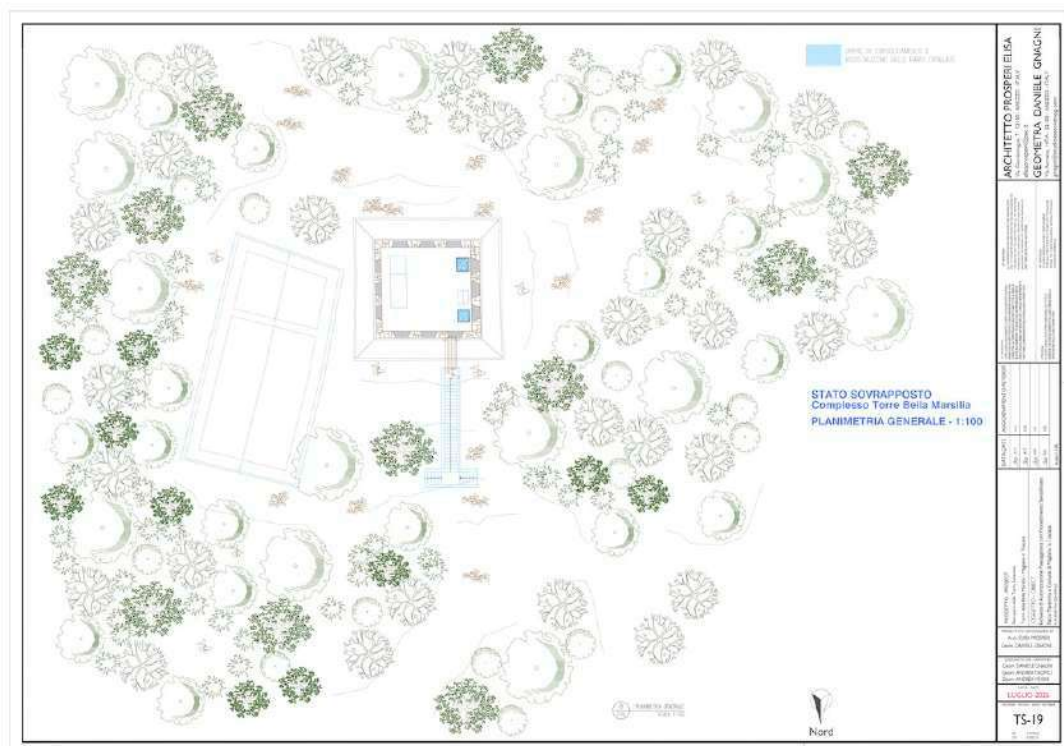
Planimetria generale stato sovrapposto Torre e Sala. Estratto Tavola TS-19 a cura dell'Arch. Elisa Prosperi e del Geometra Daniele Gnagni.
